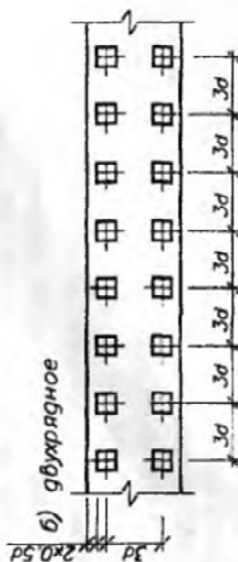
Размещение свай в ростверках под столбчатые фундаменты.
